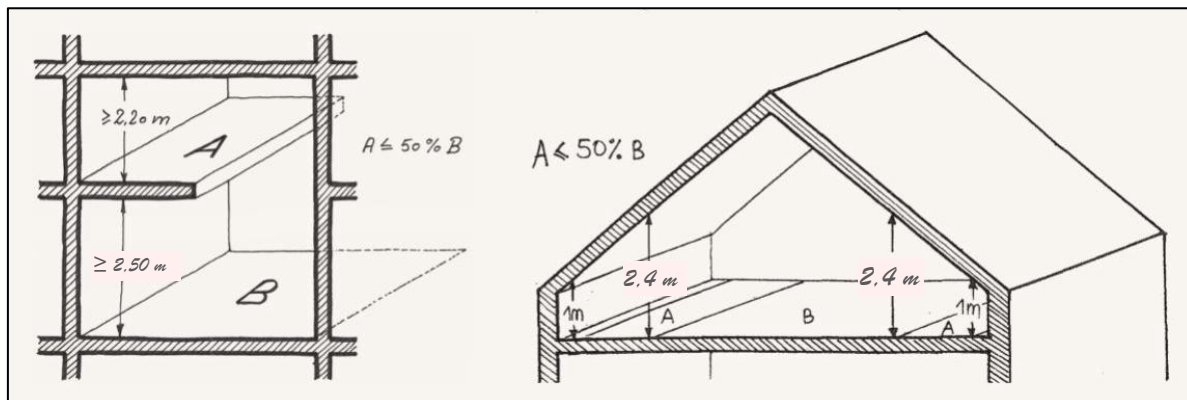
hauteur libre sous plafond en cas d'une mezzanine ou de combles Distance entre ouvertures
